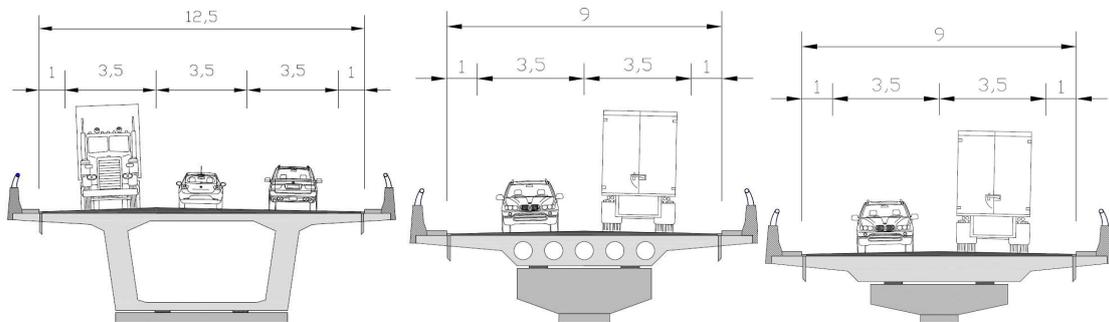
DE IZQDA A DCHA SECCIÓN TIPO PUENTE 2, PUENTE 3 Y PUENTE 4 (COTAS EN METROS)
